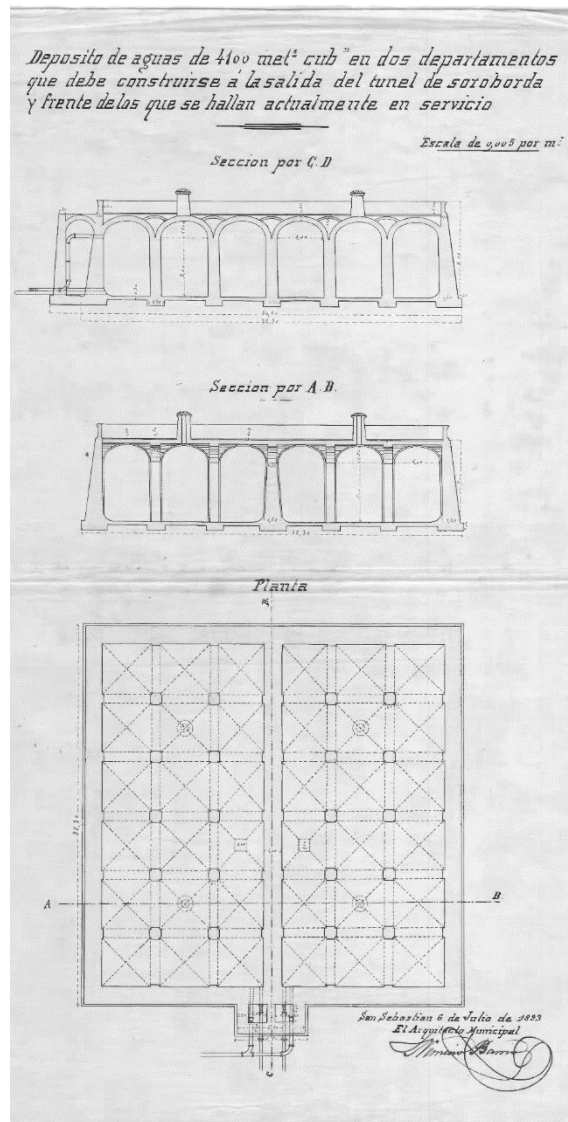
Planos del depósito de Soroborda: planta y secciones (Archivo Municipal)
